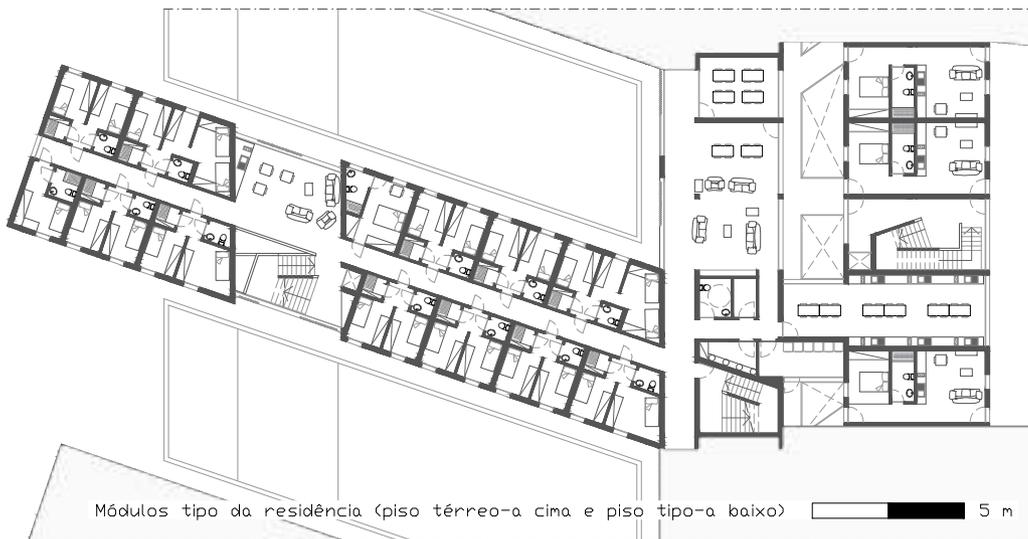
Planta piso da residência (Fonte: Marco Andrade, 2019)
